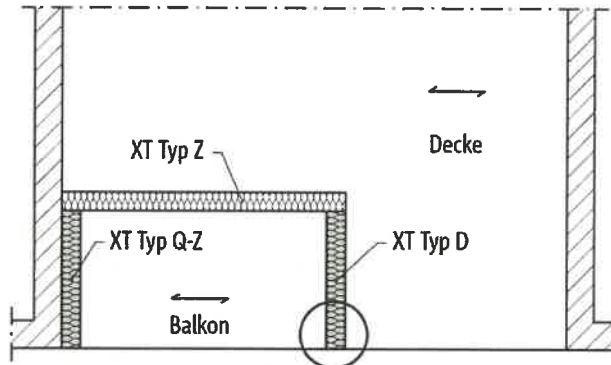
Einbausituation (Schöck Isokorb® XT Typ D)
